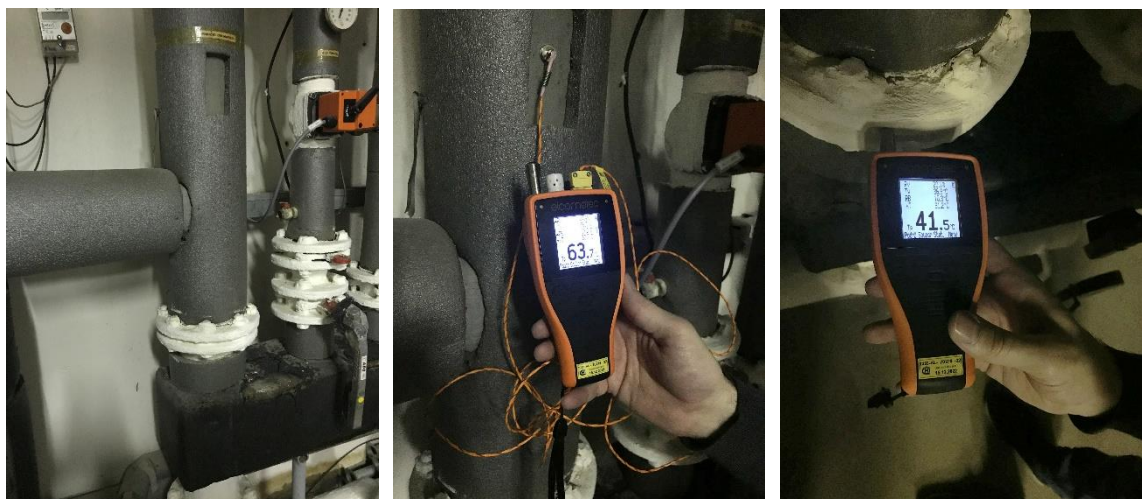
Vyobrazení měřených bodů vrat parního kotle
